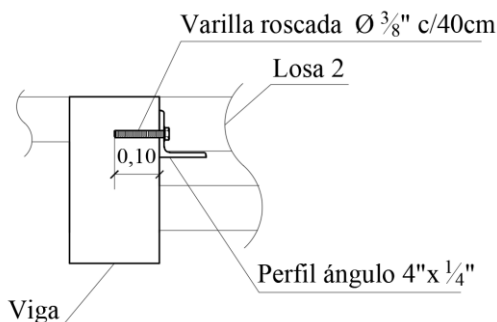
Esquema de anclaje de perfil ángulo para apoyo de la losa nueva.
